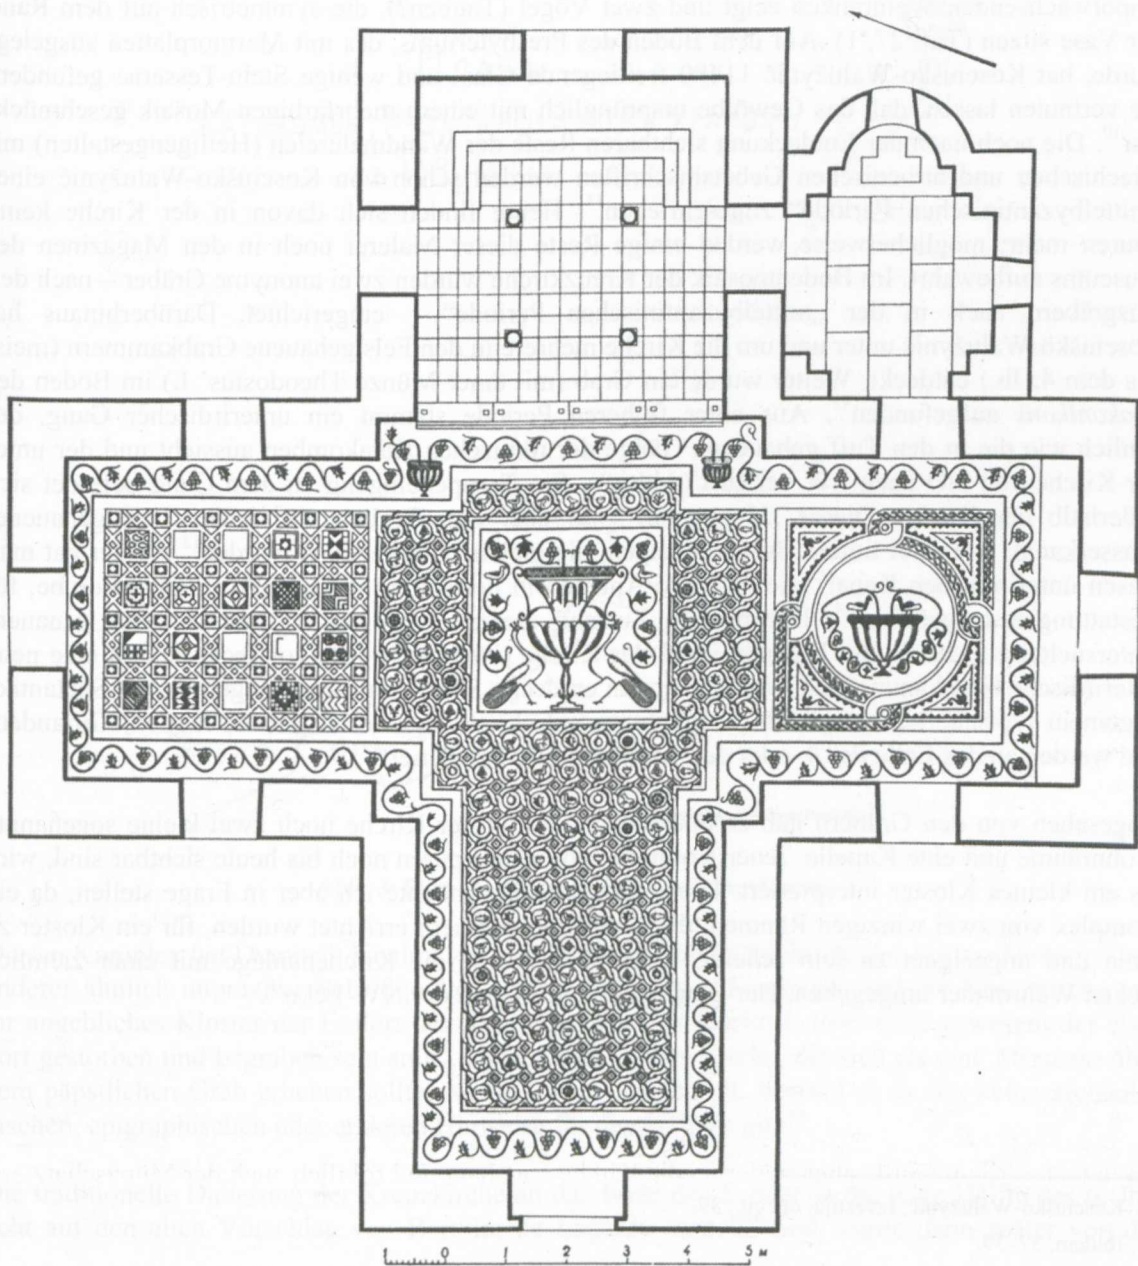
Grundriss der Kirche mit Mosaikboden
